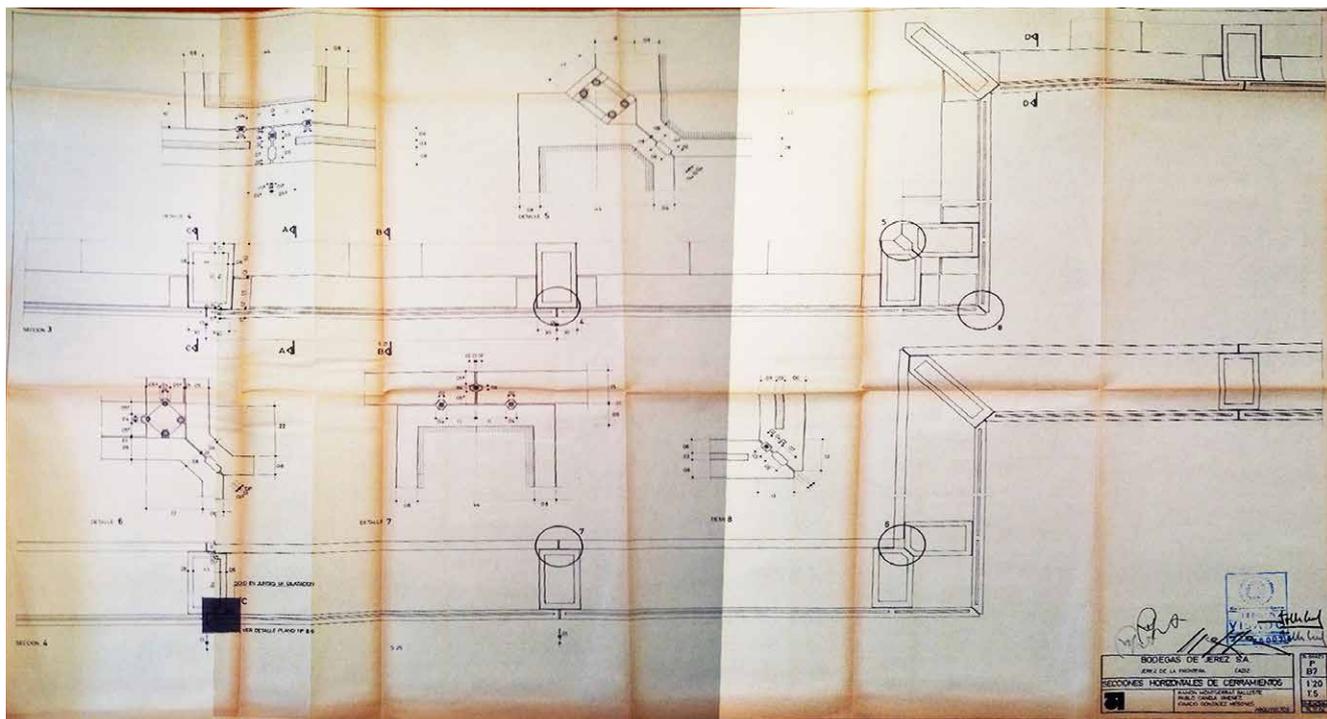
Sección horizontal de cerramiento. Detalles. Fuente: Archivo Colegio de Arquitectos de Cádiz.
